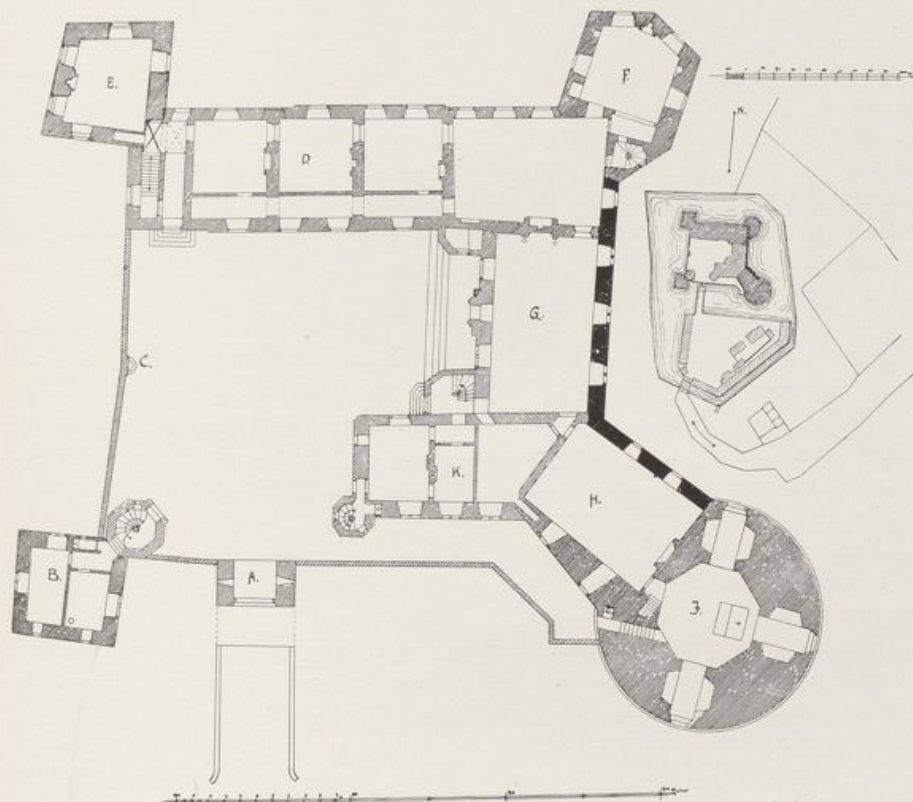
Schloss Merode. Lageplan und Erdgeschoss-Grundriss der Hauptburg.
